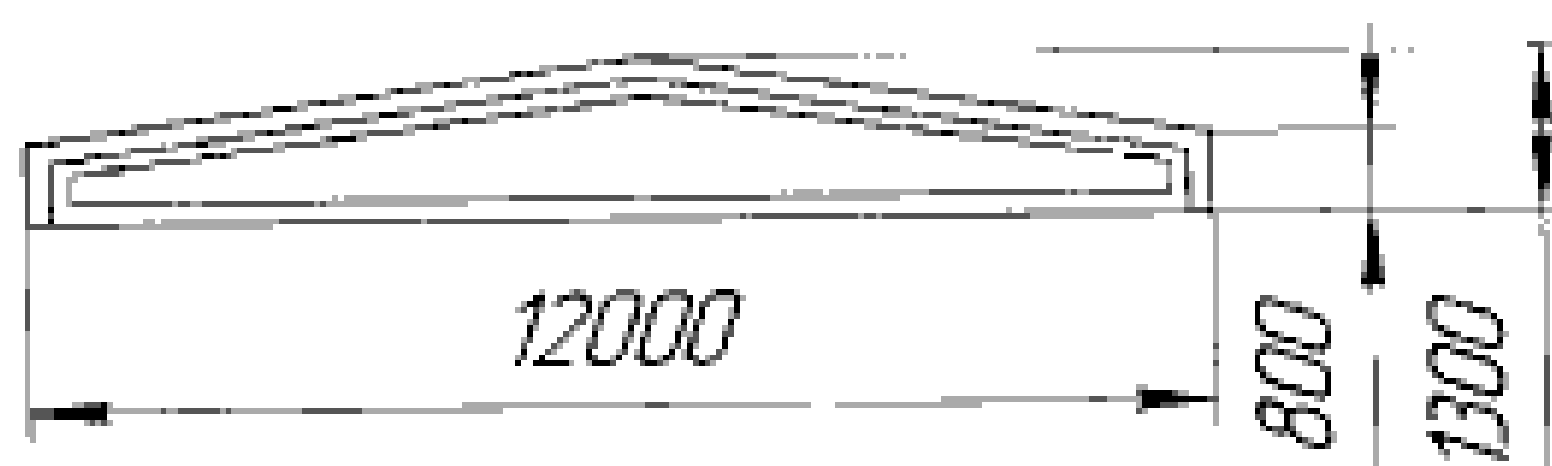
Железобетонная ферма серии 1.462-3
